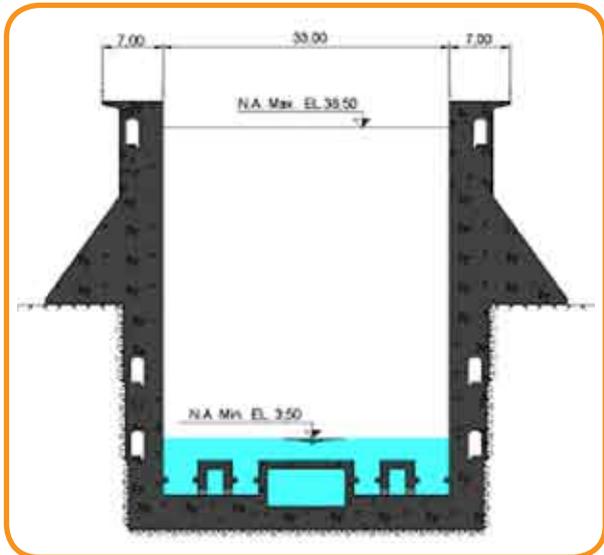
Corte Transversal Esquemático da Eclusa II, onde podem ser vistos os níveis d'água e a largura da câmara.
